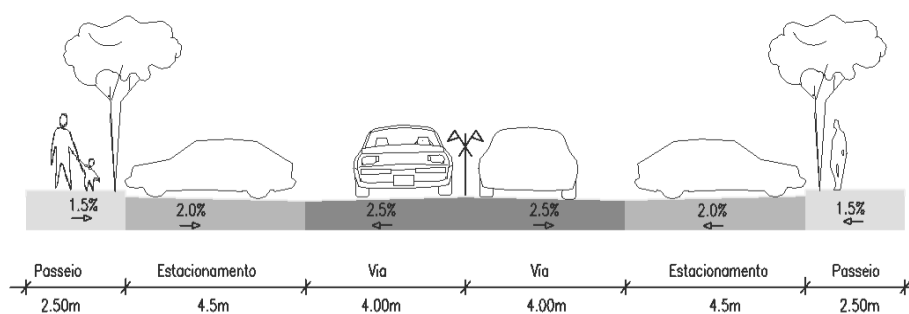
Perfil Transversal Tipo 3 – Eixos 5.1
